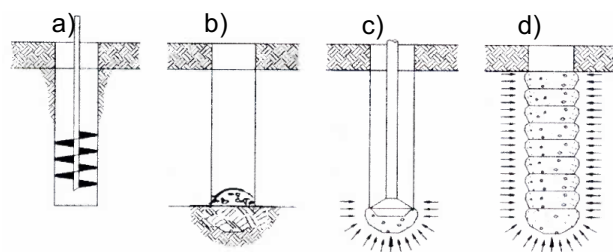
Procedimiento constructivo: a) Perforación, b) Colocación de grava, c) apisonado, d) esquema final de un elemento.
